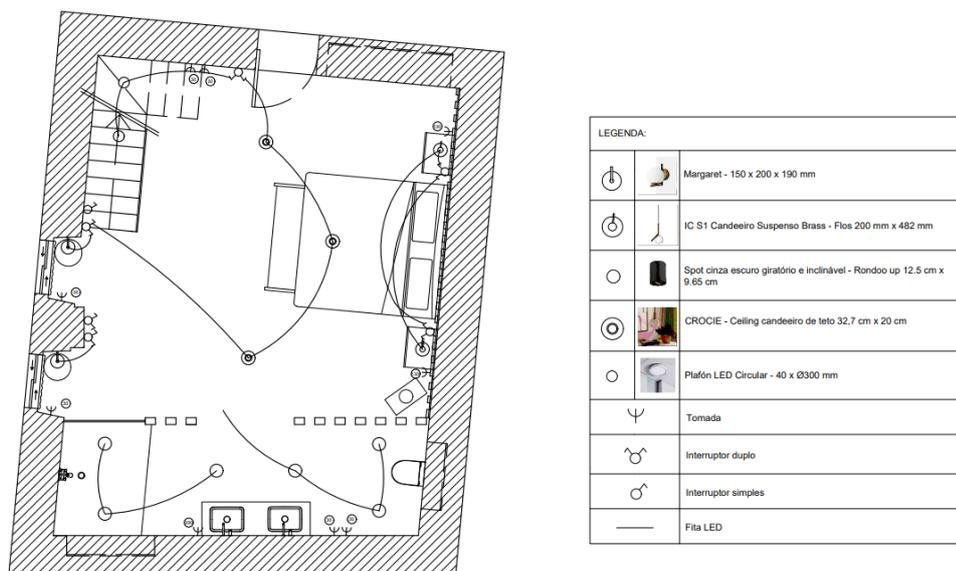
Planta de iluminação e tomadas piso -1. Fonte: Maria Leonor.
